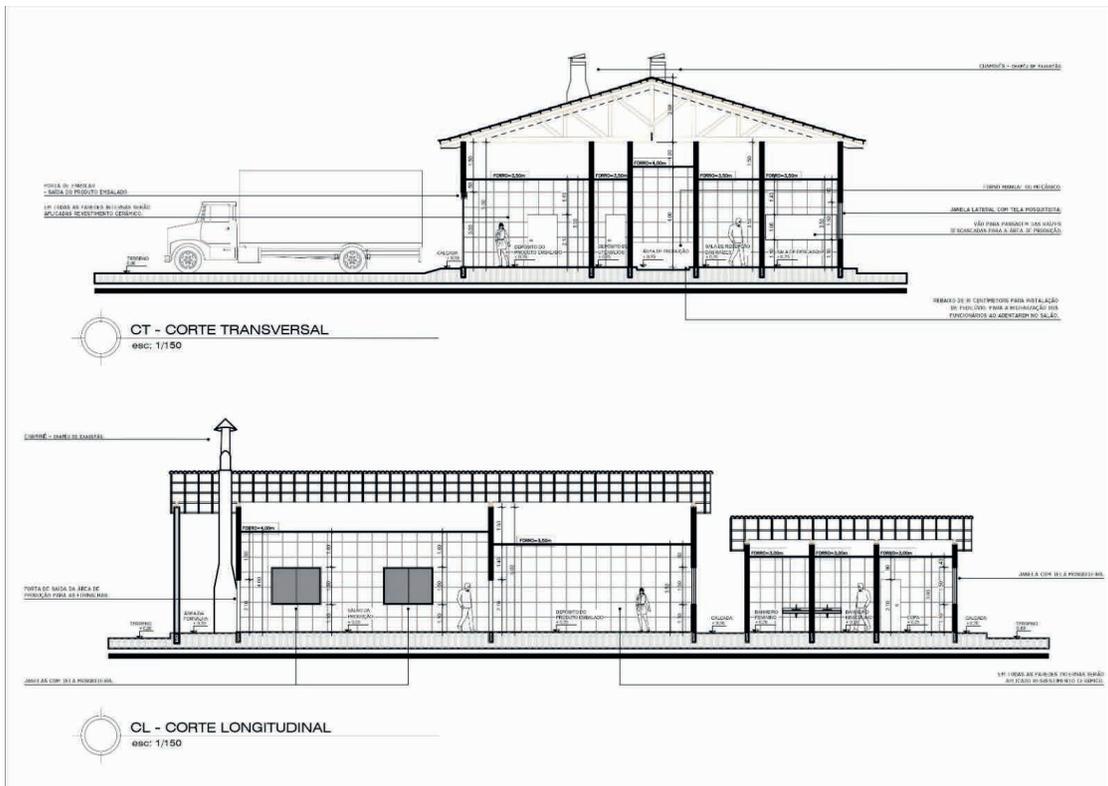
Cortes transversal e longitudinal do layout proposto para a casa de farinha em estudo
